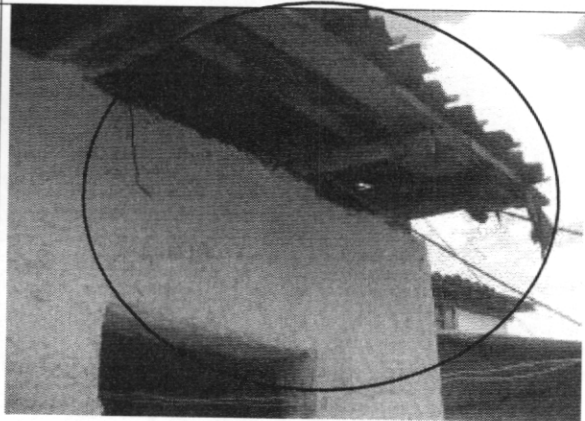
Desprendimiento de elementos de cubierta, interiores 18 a 22
